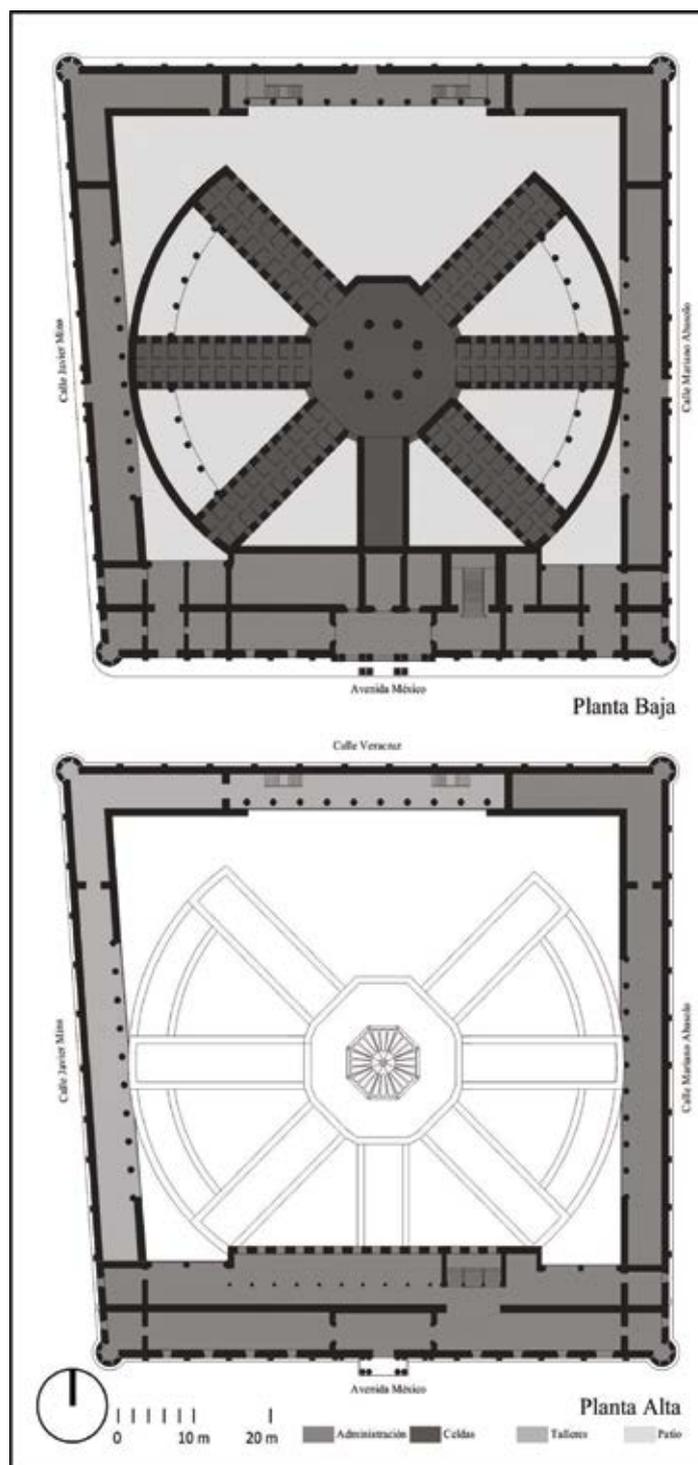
Reconstrucción de la planta arquitectónica baja y alta de la Penitenciaría de Tepic en 1908.
